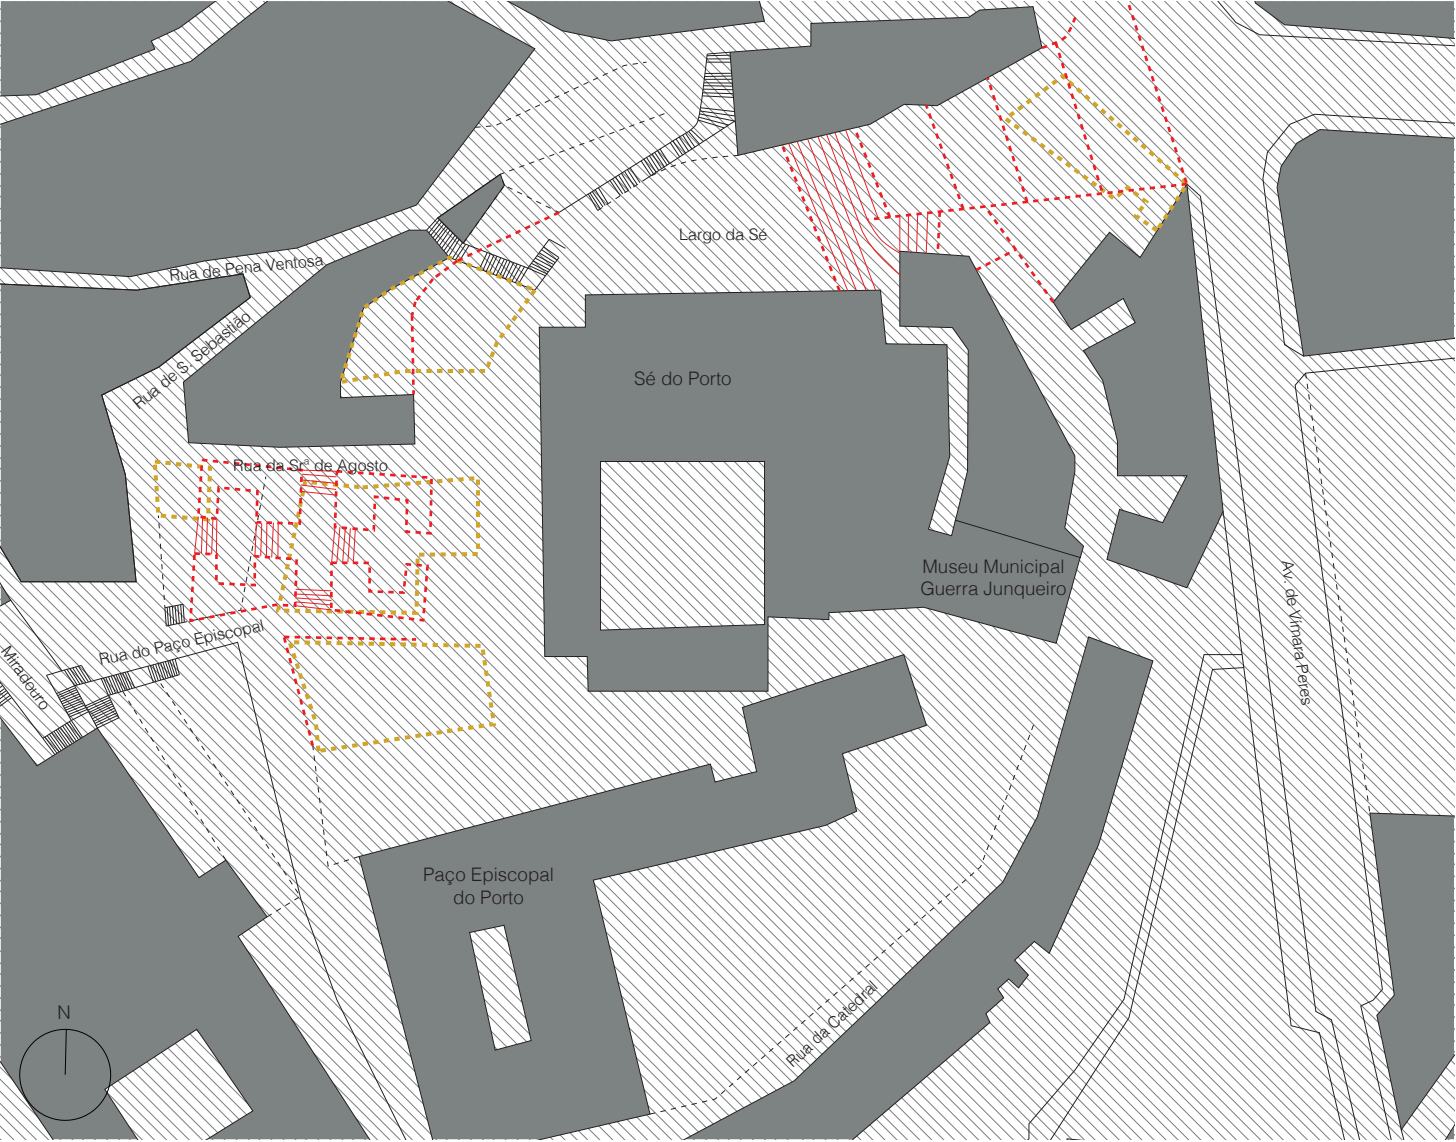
Planta esquemática do tipo cheio/vazio, correspondente à segunda proposta.
